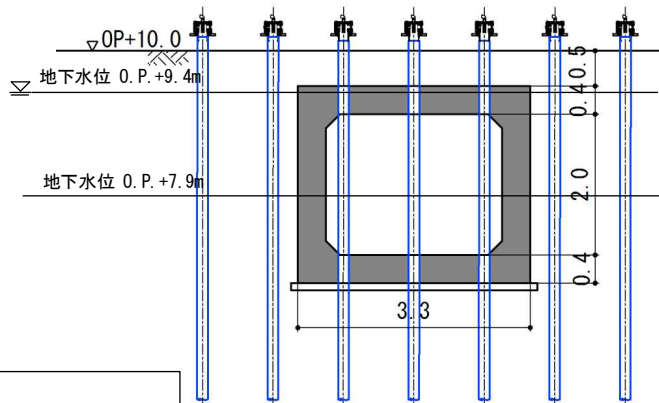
【6-7】4号機主変圧器ケーブルダクト 施工方法（貫通施工）
